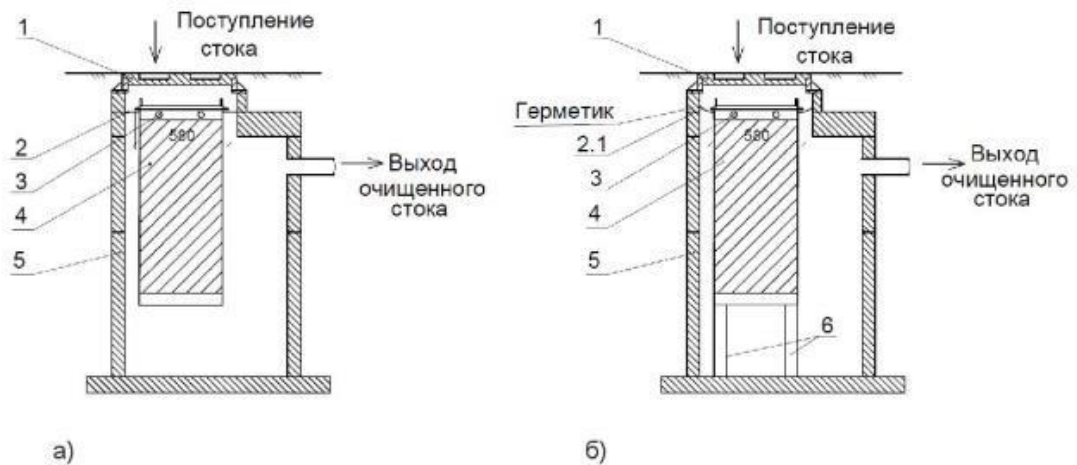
Схема установки фильтр-патрон $\varnothing 580$ мм под люком на бетонной плите перекрытия колодца
